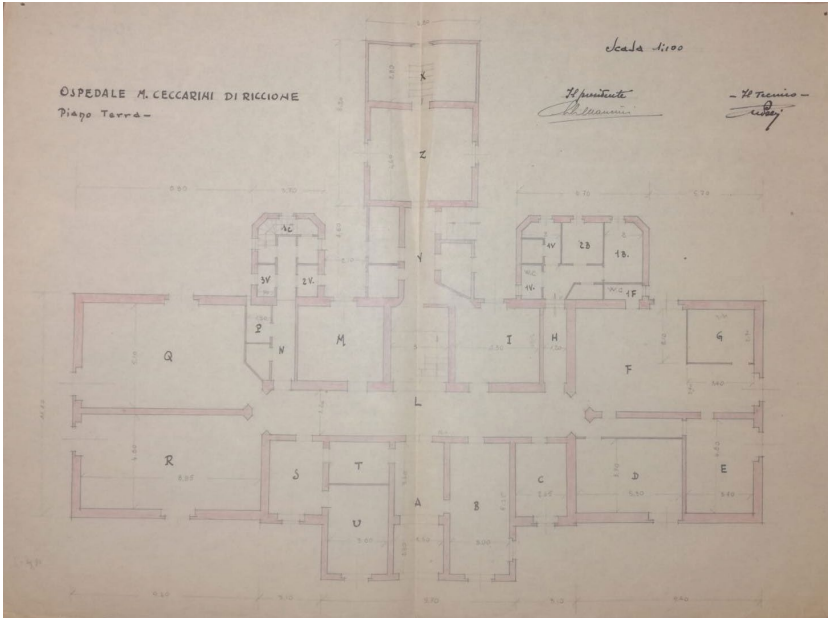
e 13 Planimetrie dell'Ospedale (piano terra e primo piano).
